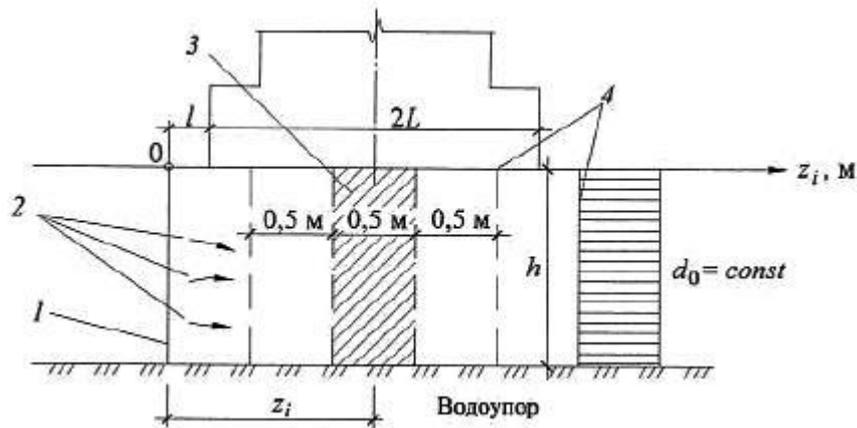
Схема для расчета рассоления основания при горизонтальной фильтрации
